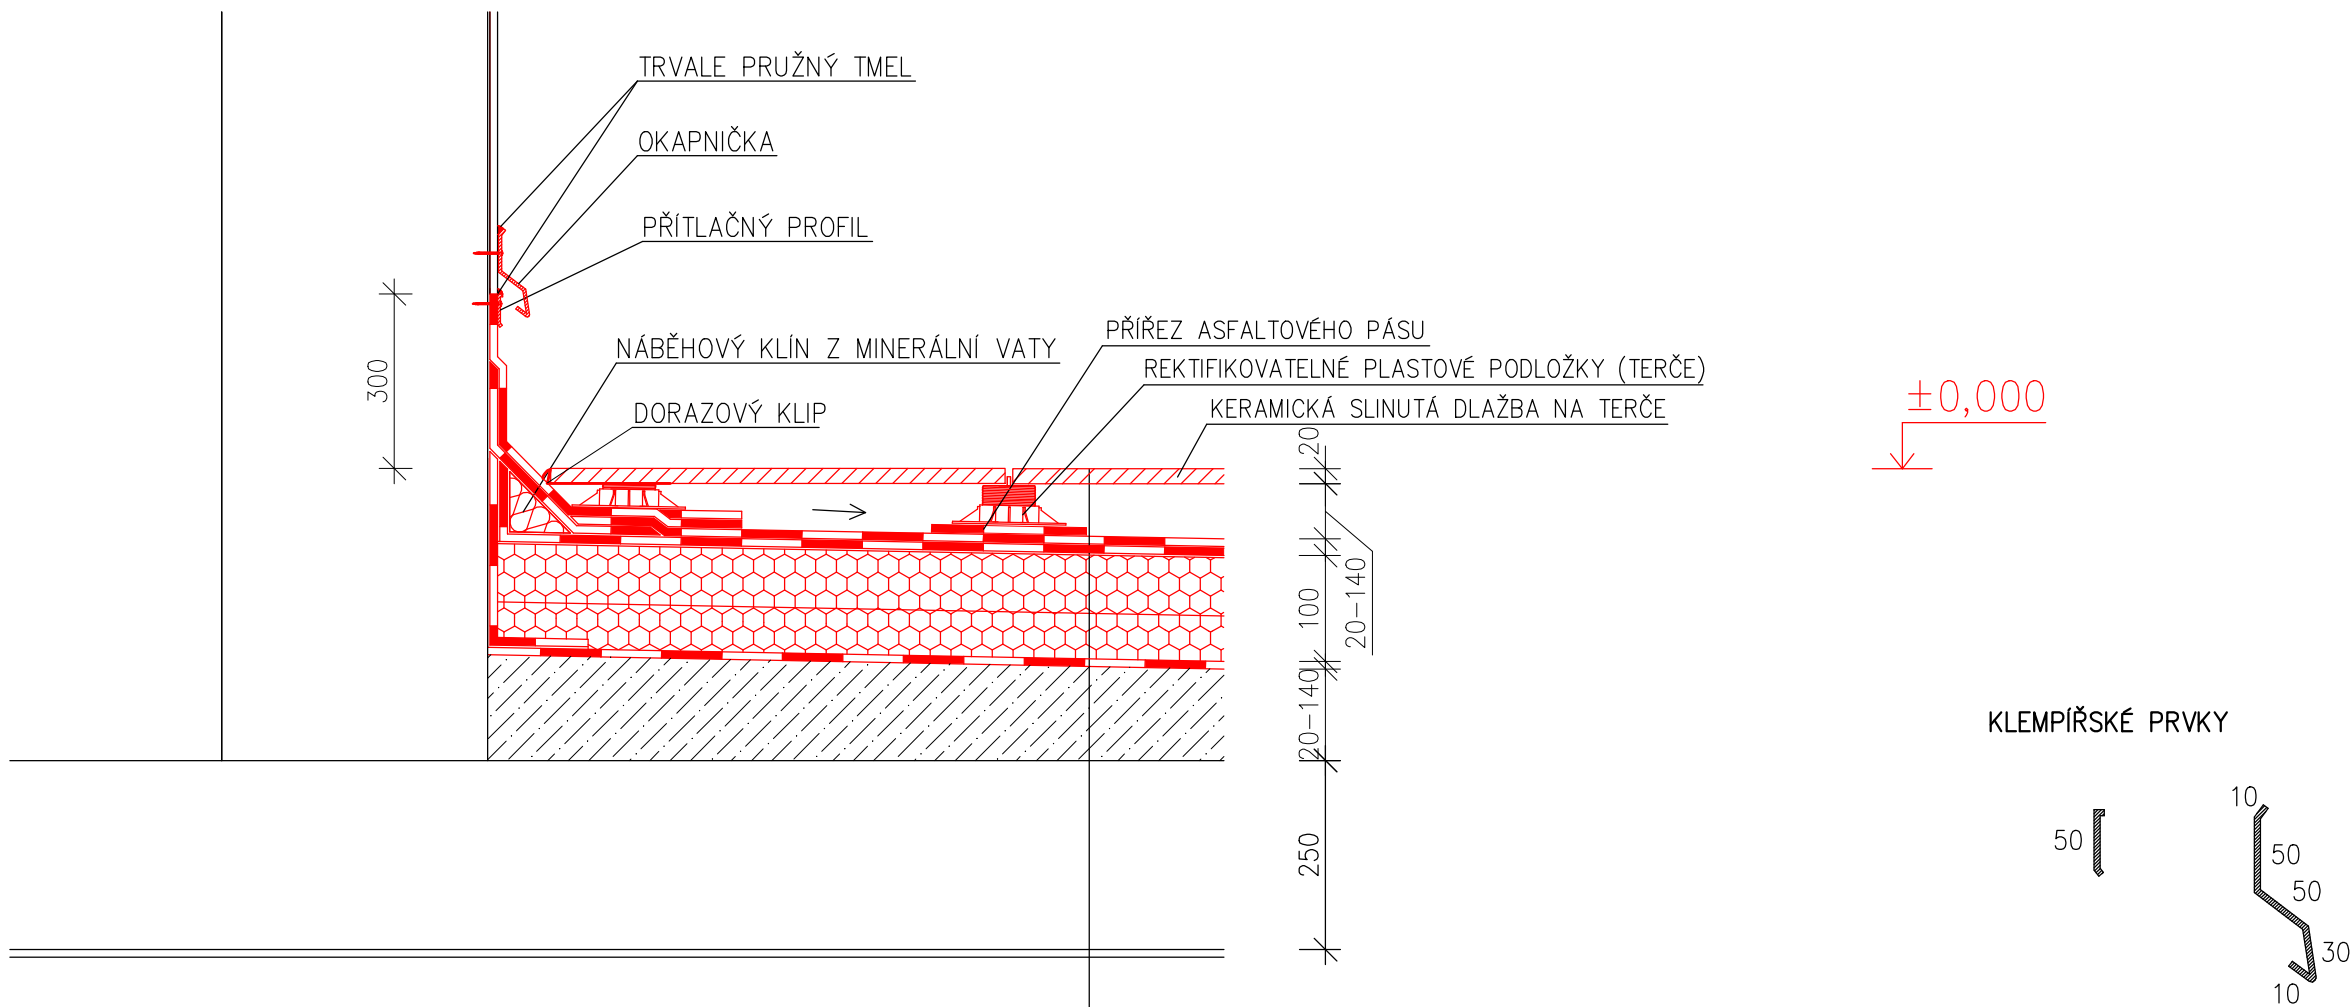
DETAIL B – UKONČENÍ HYDROIZOLACE U STĚNY 1:10
